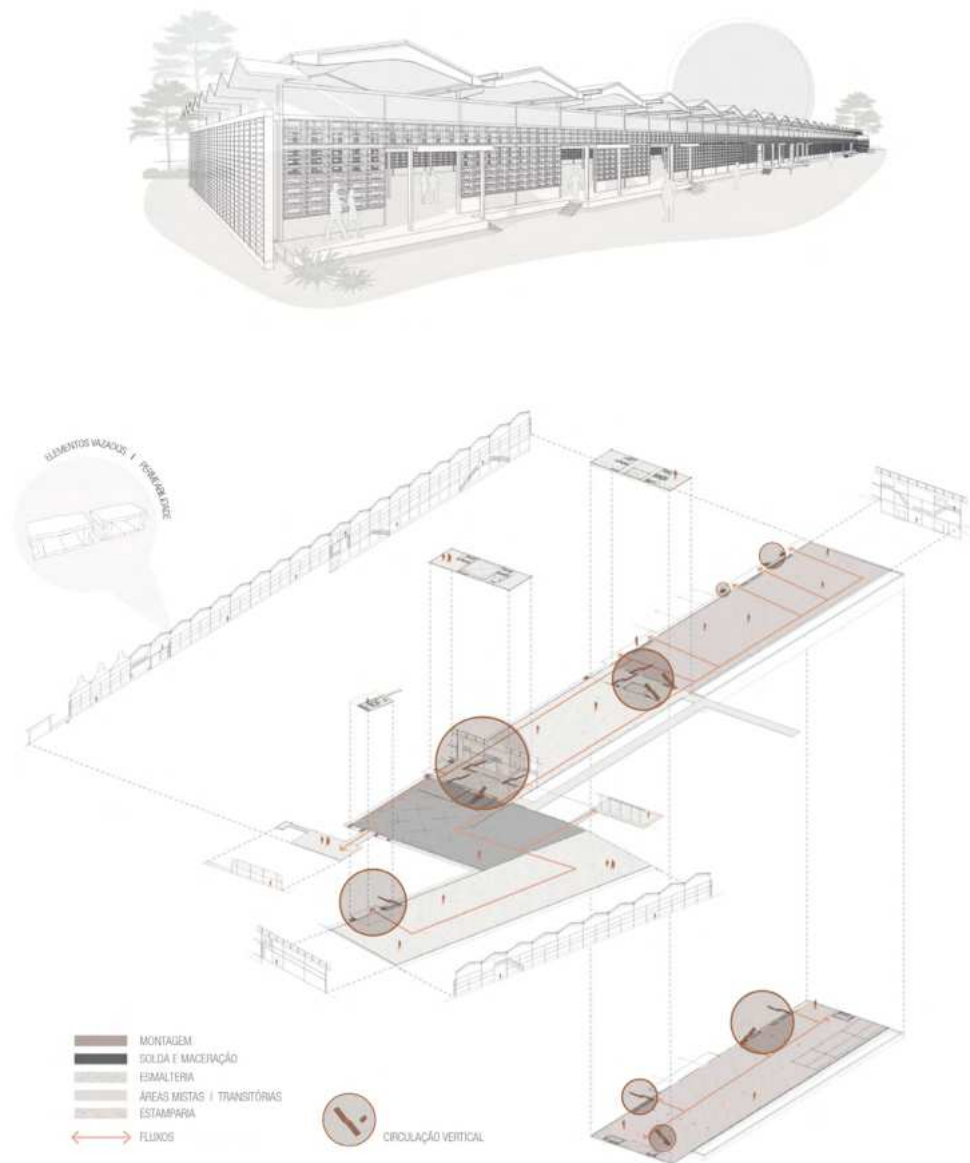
Perspectiva Pavilhão Principal e Esquema Isométrico Planta e Fachadas Wallig Nordeste S.A..
